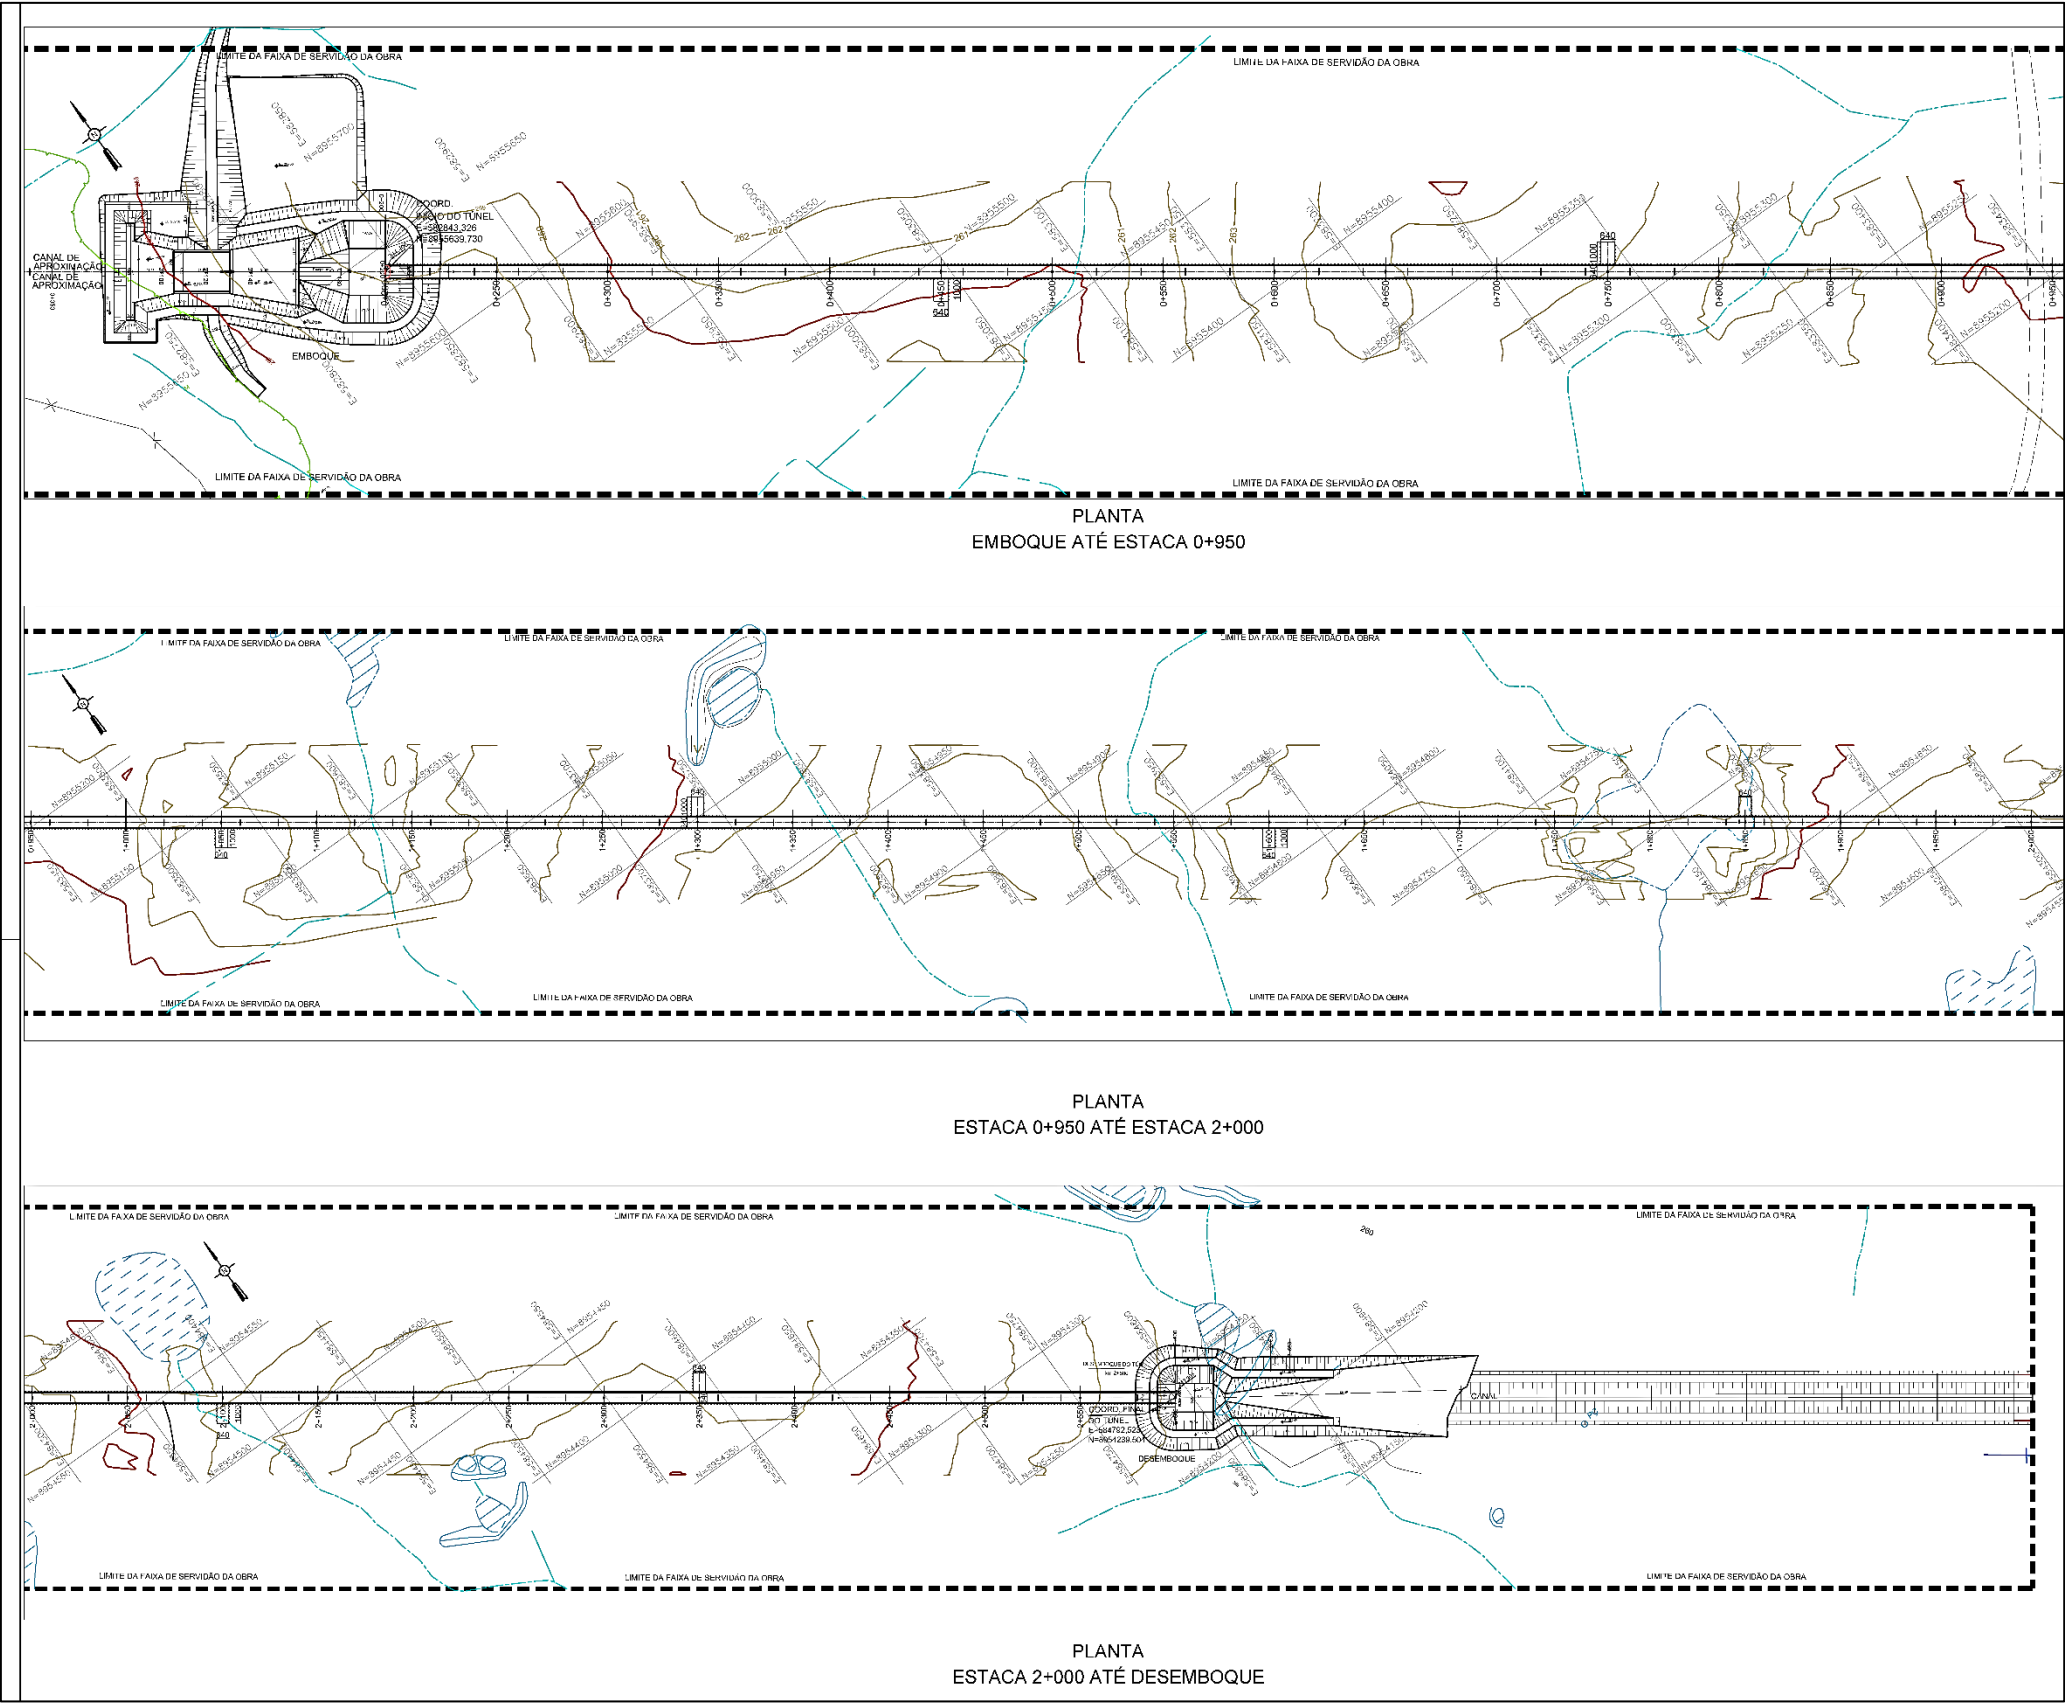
Planta de Situação do Túnel Vila Matias.
